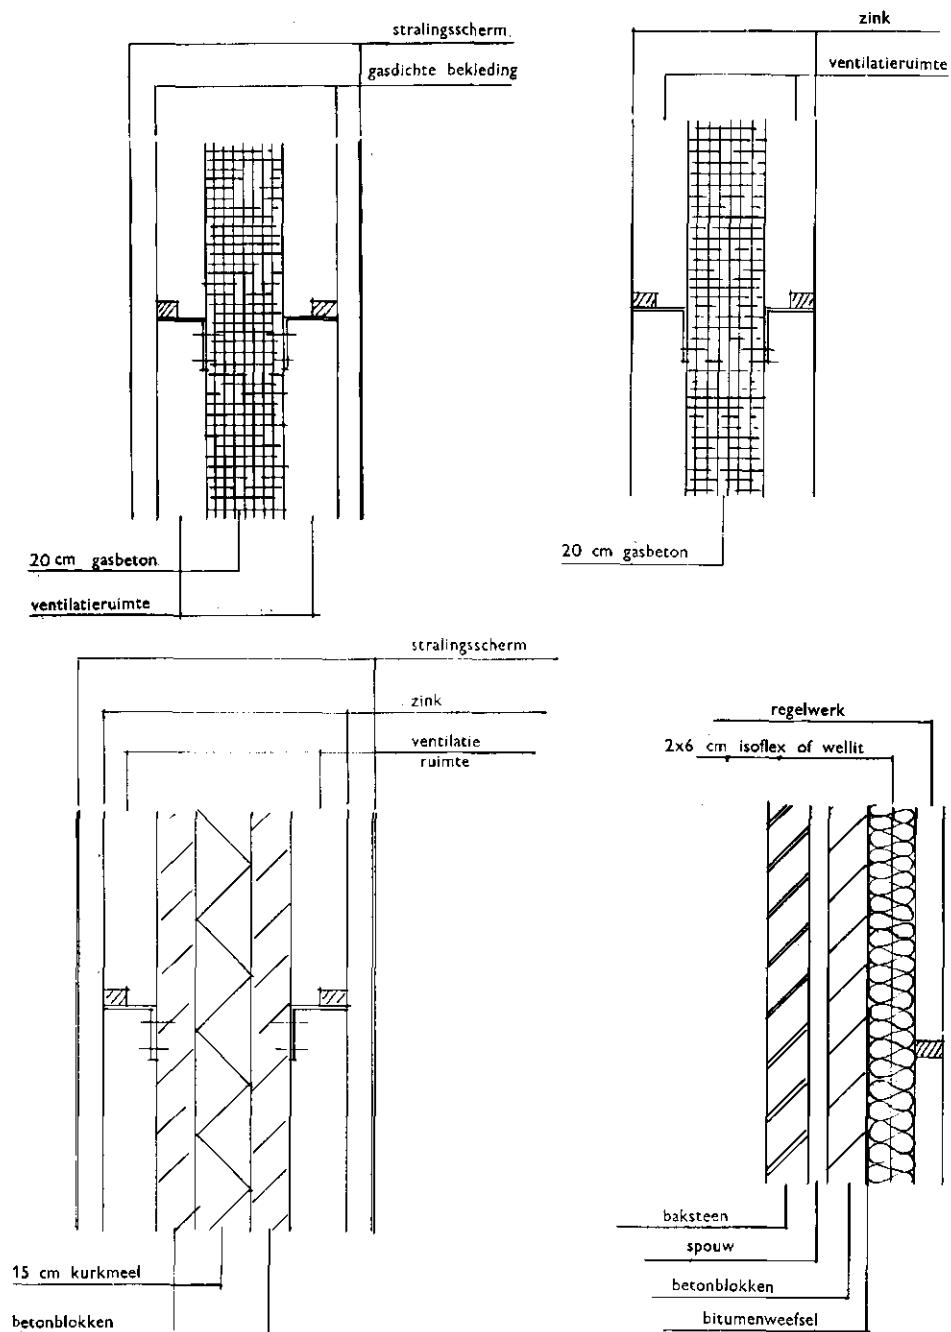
Enkele constructiemogelijkheden voor scheidingswanden.
